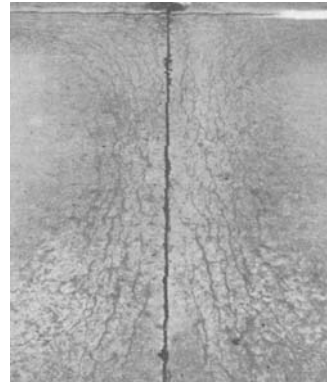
Innerer Gefügeschädigung an einer Betonfahrbahndecke [Pig 95]
